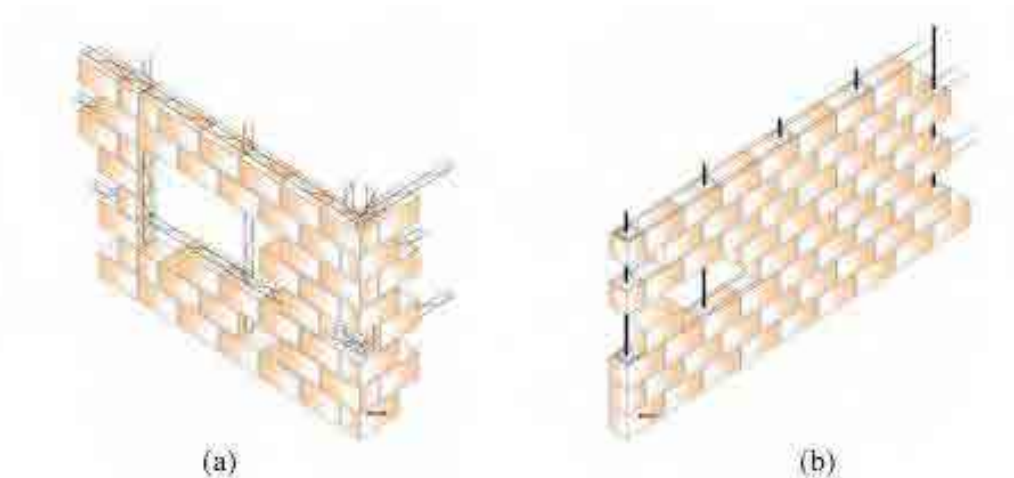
(a) Alvenaria estrutural armada com treliças e (b) Alvenaria estrutural armada com vergalhões
